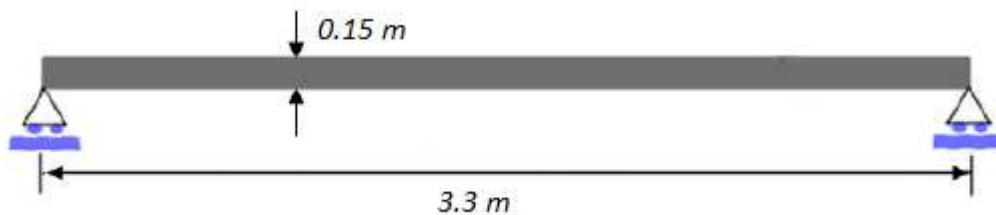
Assimilation de la paillasse à une poutre horizontale simplement appuyée.
